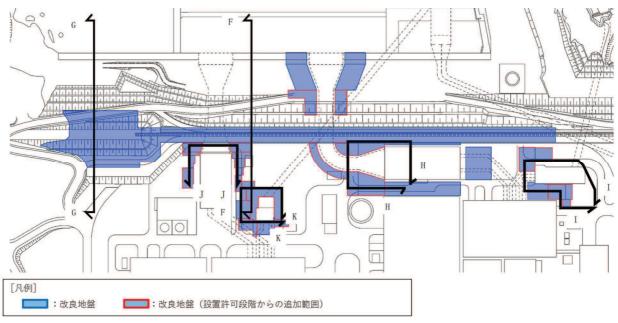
地盤改良体の平面配置図(防潮堤,防潮壁,防潮堤(第3号機取水路横断部))
